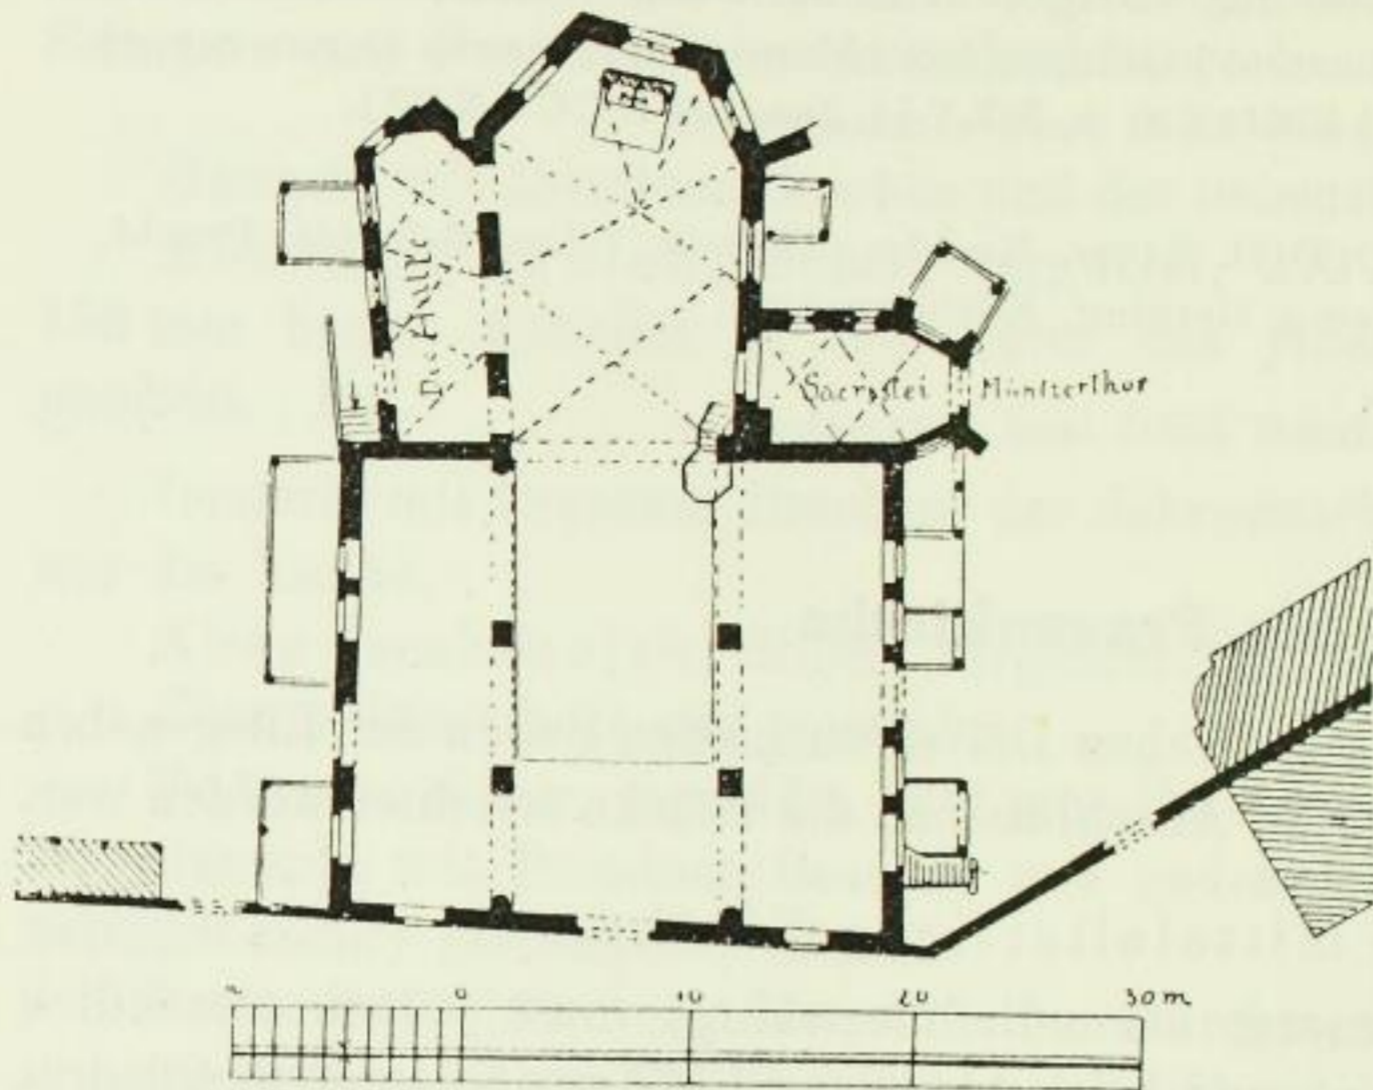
Grundriss der Frauenkirche, Zustand zu Anf. 18. Jahrh.
